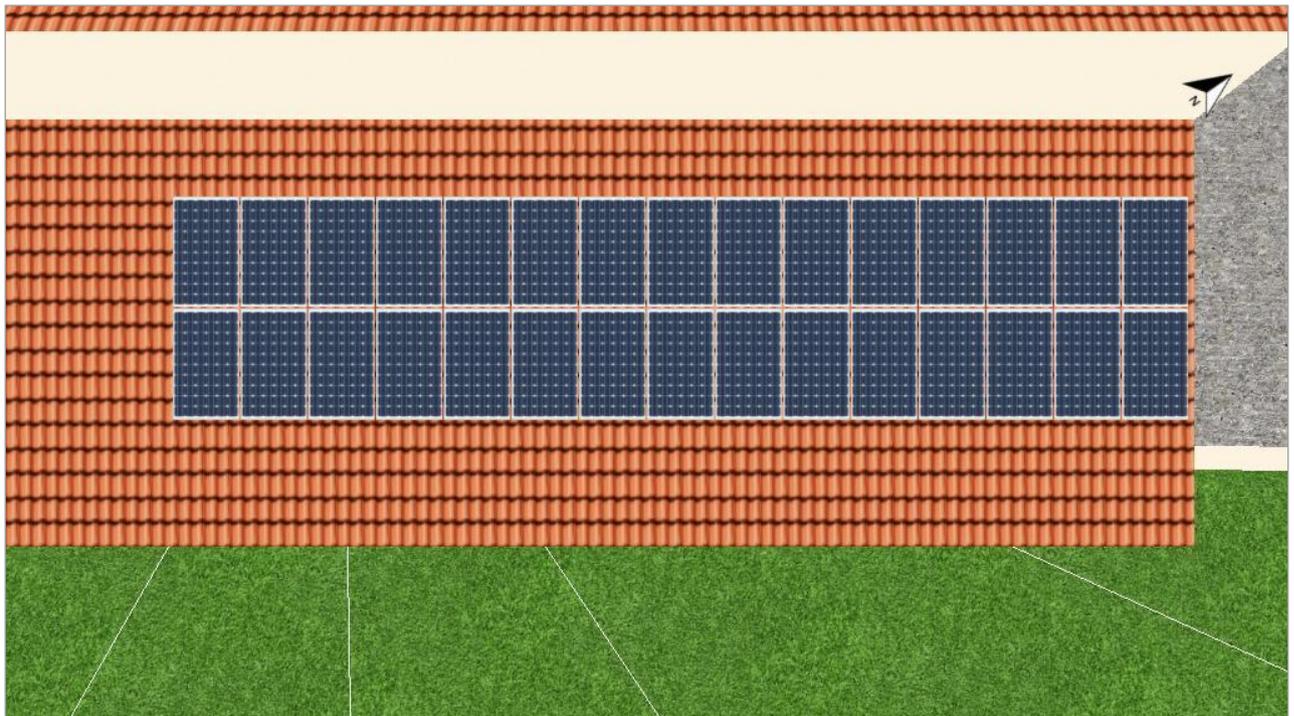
Modulfläche - Gebäude 02-Dachfläche Südost
